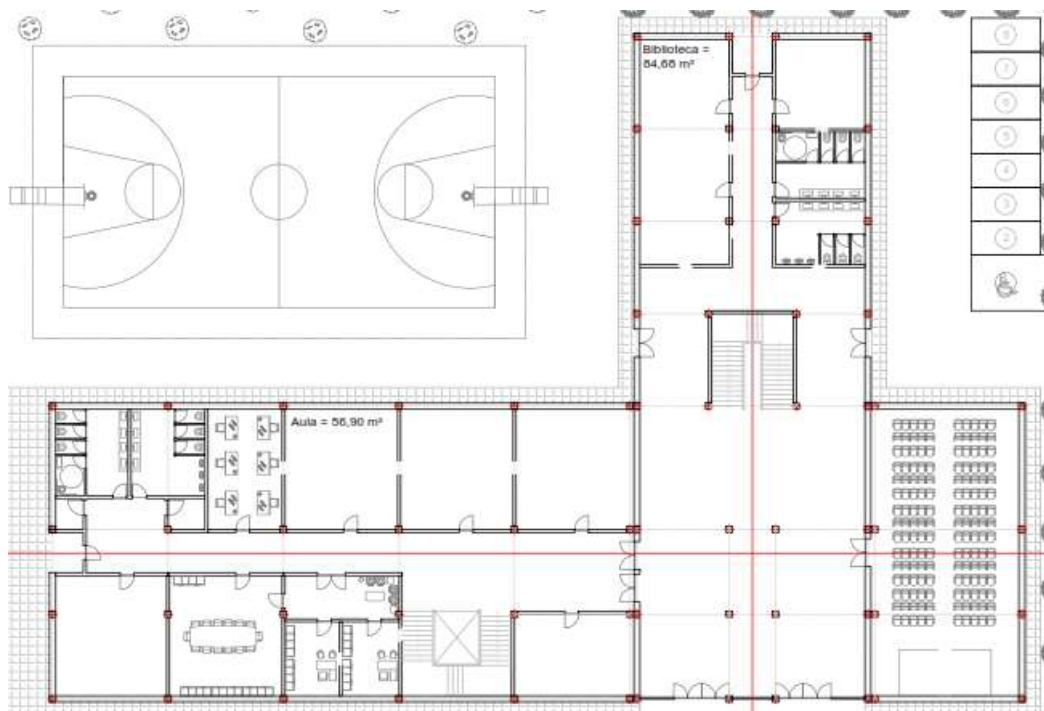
Vista general del conjunto, extraída del plano 2.1.
